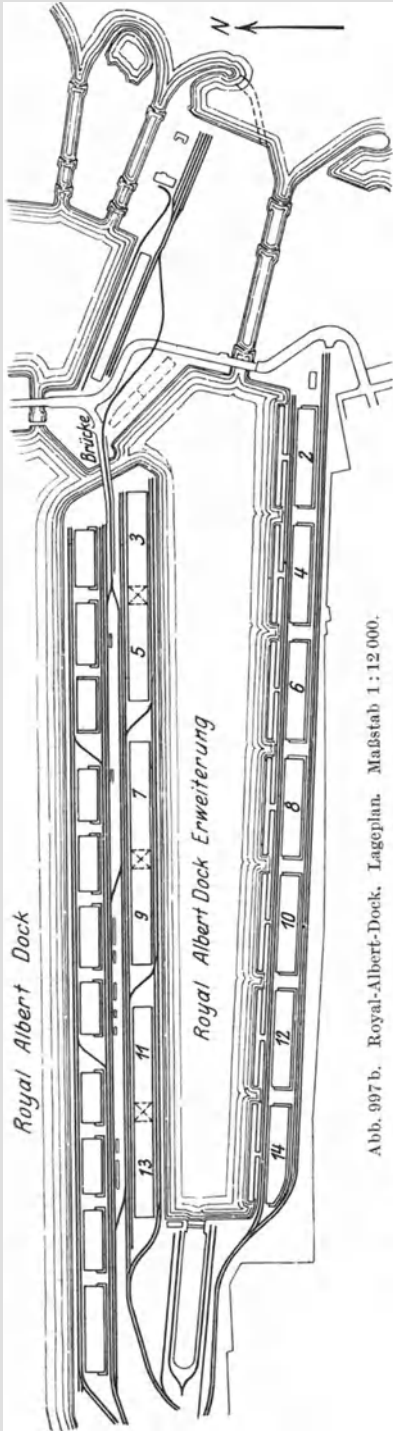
Royal-Albert-Dock, Lageplan, Maßstab 1 : 12 000.
